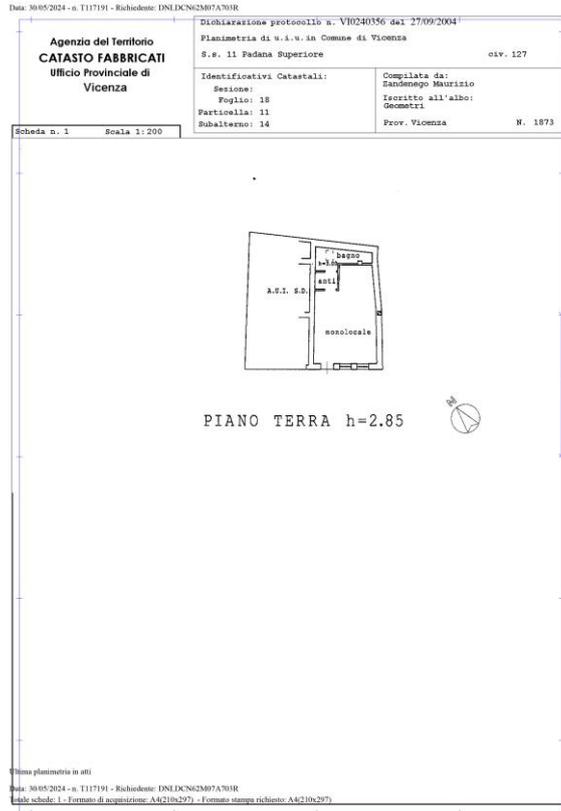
Planimetrie catastali dei beni (Allegato 2)
